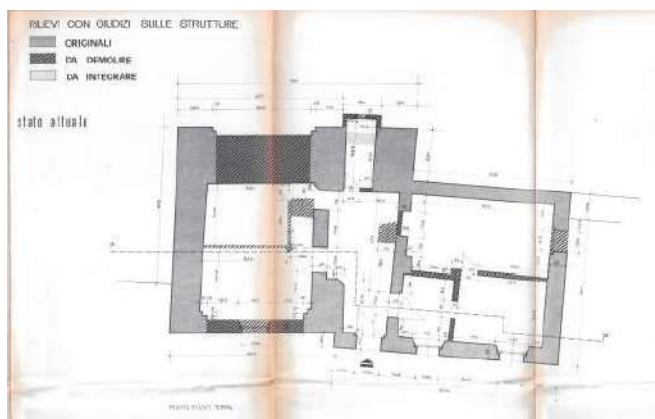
e 5 - Pianta e sezione con modifiche – FRIET 1985
